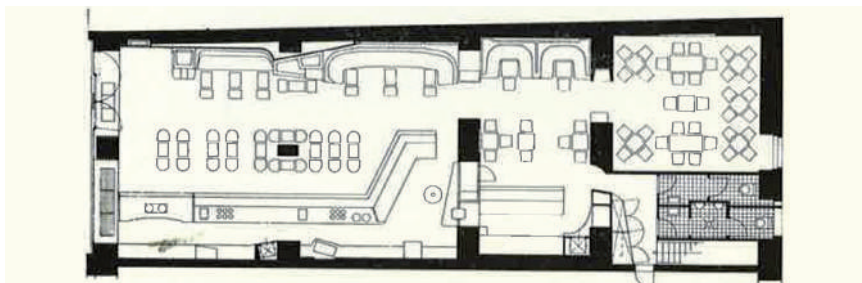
Arabia am Kohlmarkt*, Grundriss Erdgeschoss, CAD-Plan, publiziert in DER BAU 1952, Heft 1/2, S. 8, Oswald Haerdtl, 1951/52.
